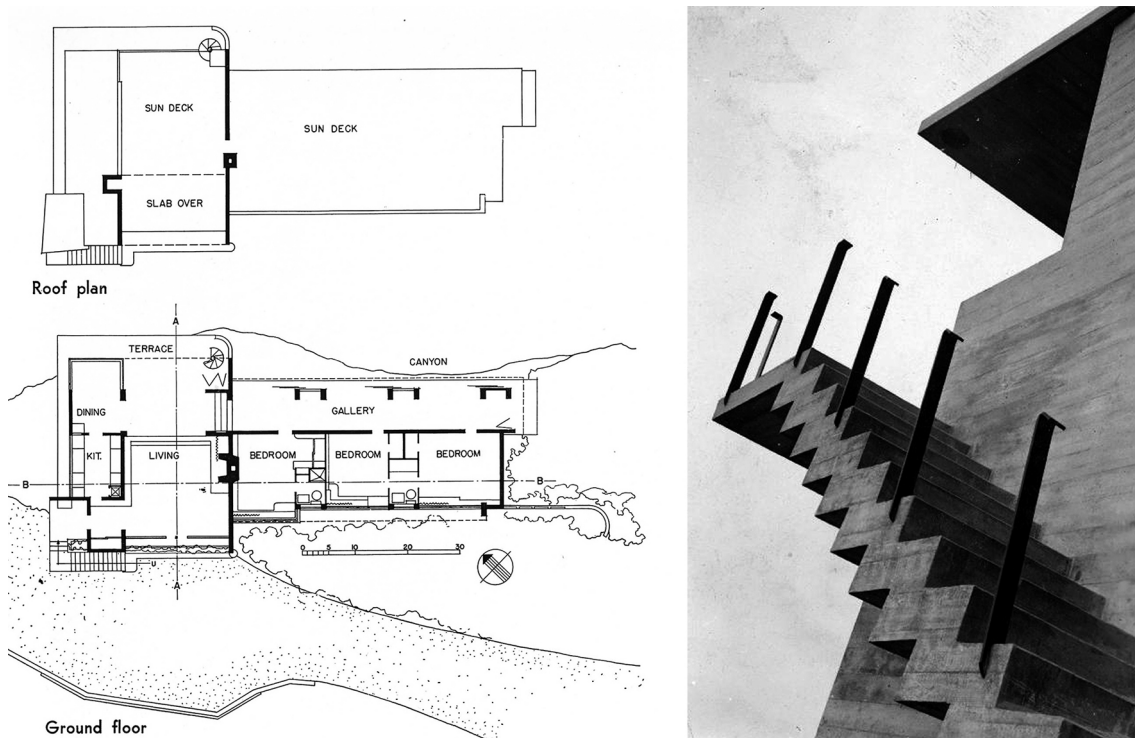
Alexander, Halliburton House, plantas y detalle de la escalera en construcción
